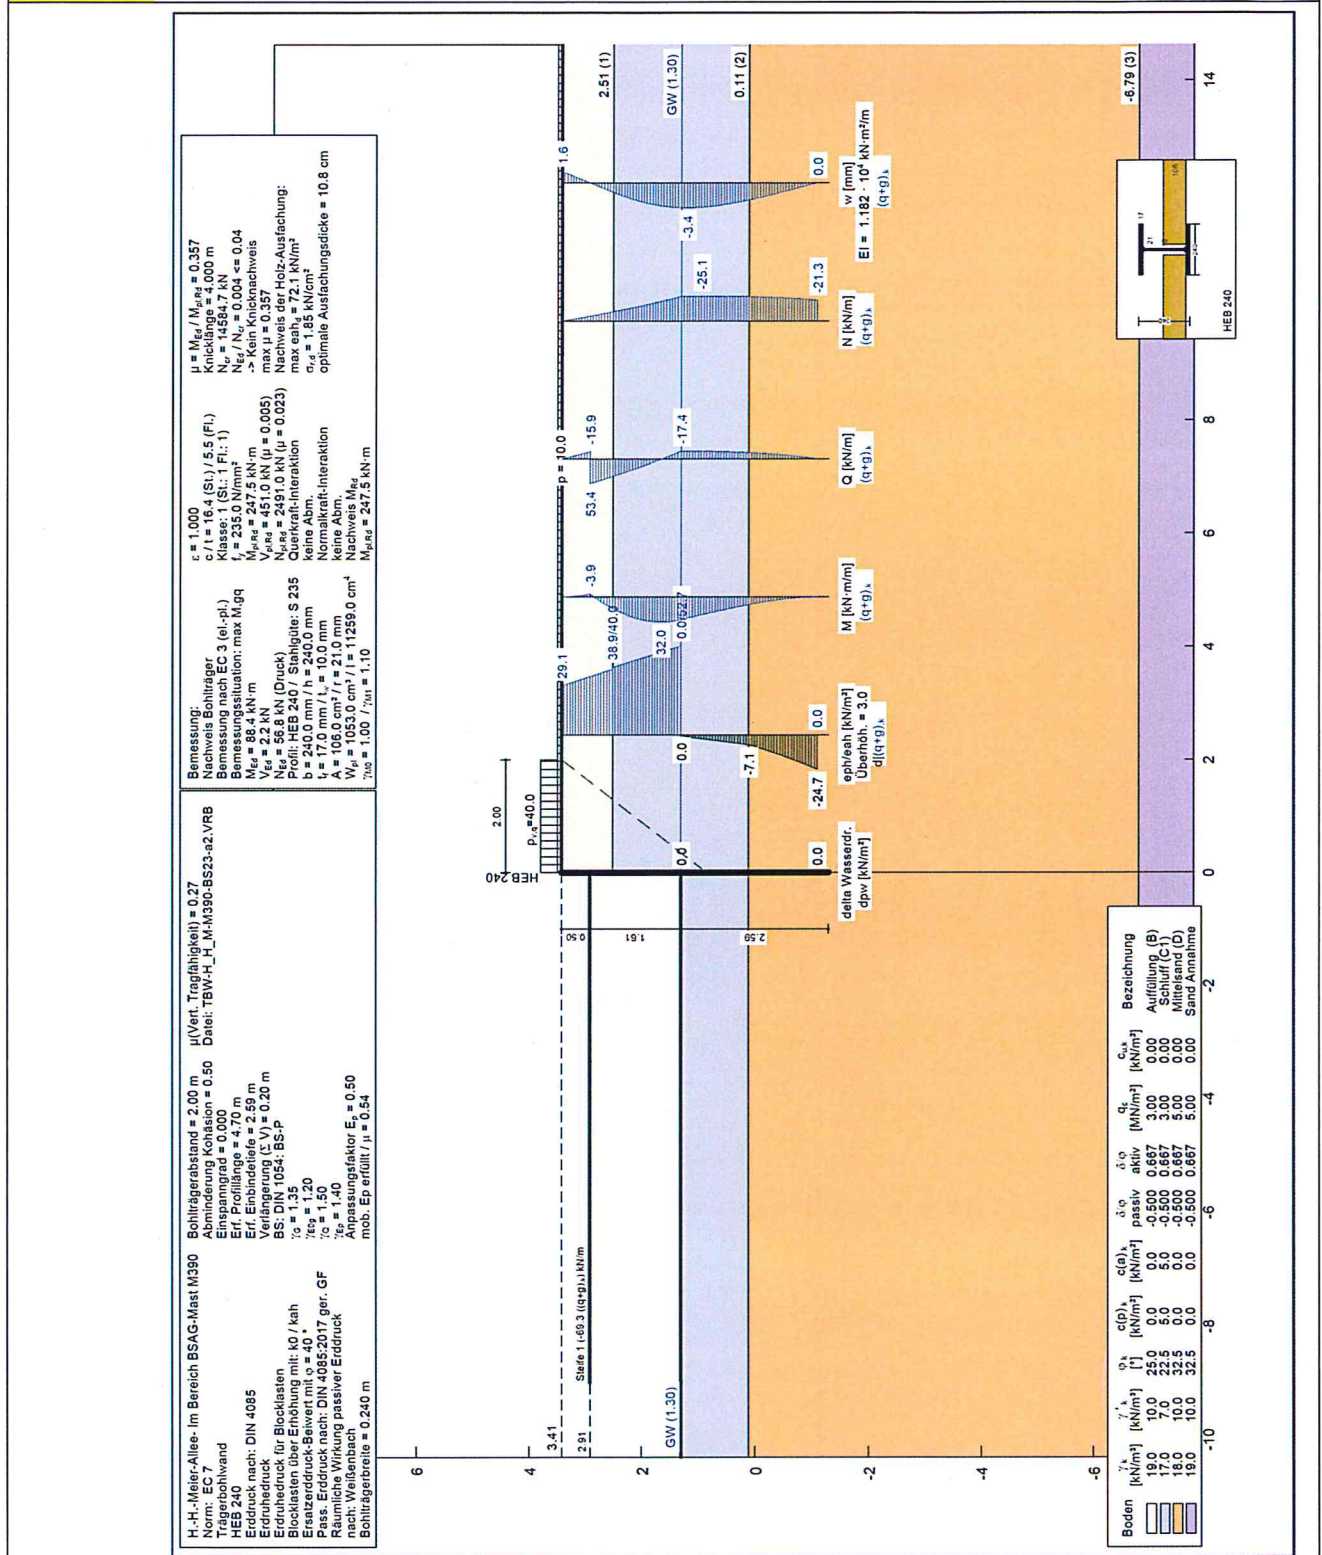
b1 Trägerbohlwand mit Strassenbahnlasten+Mast – BS21 max M_{Mast}-b1
